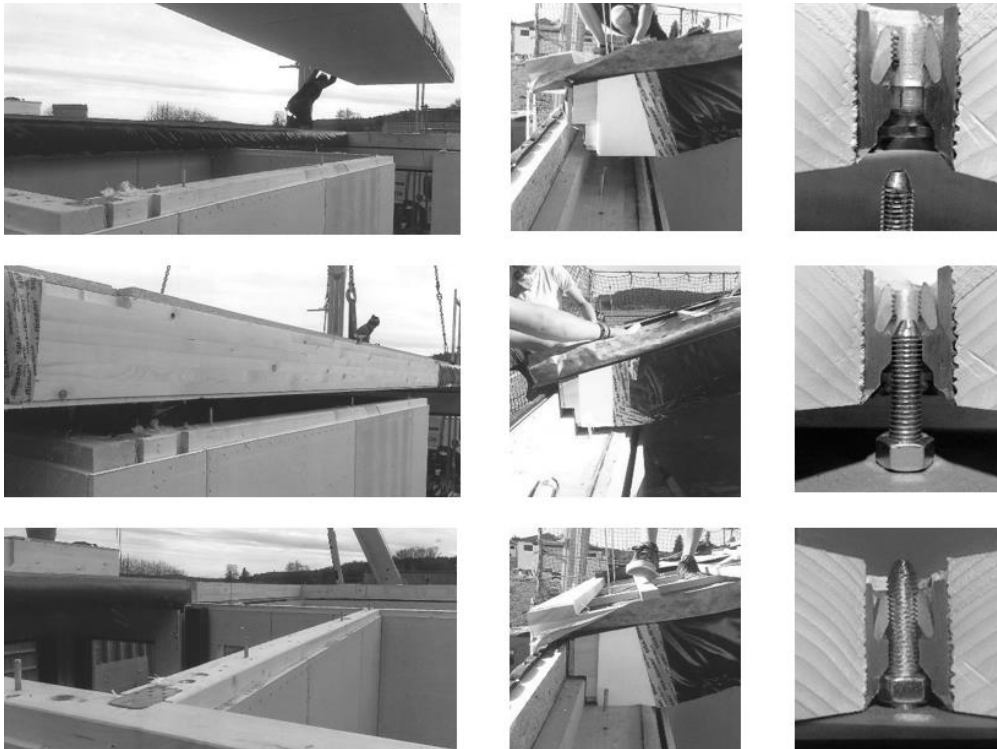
Element-Montage Decke und Dach, mit STEXON® Foto: Bau Fritz
